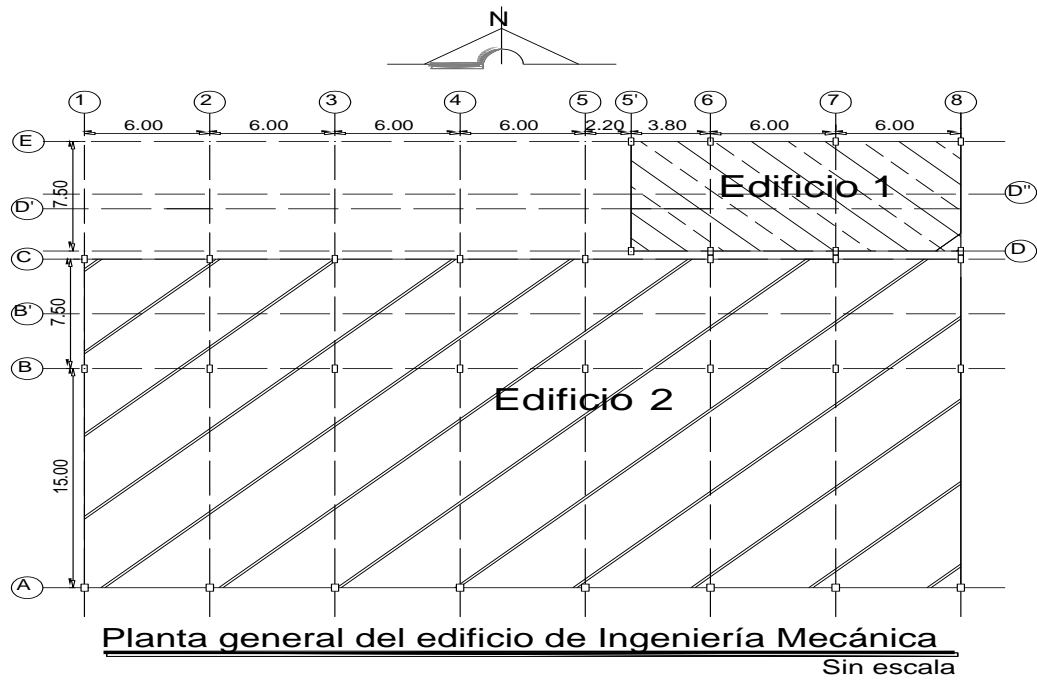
Planta general del edificio de Ingeniería Mecánica.
